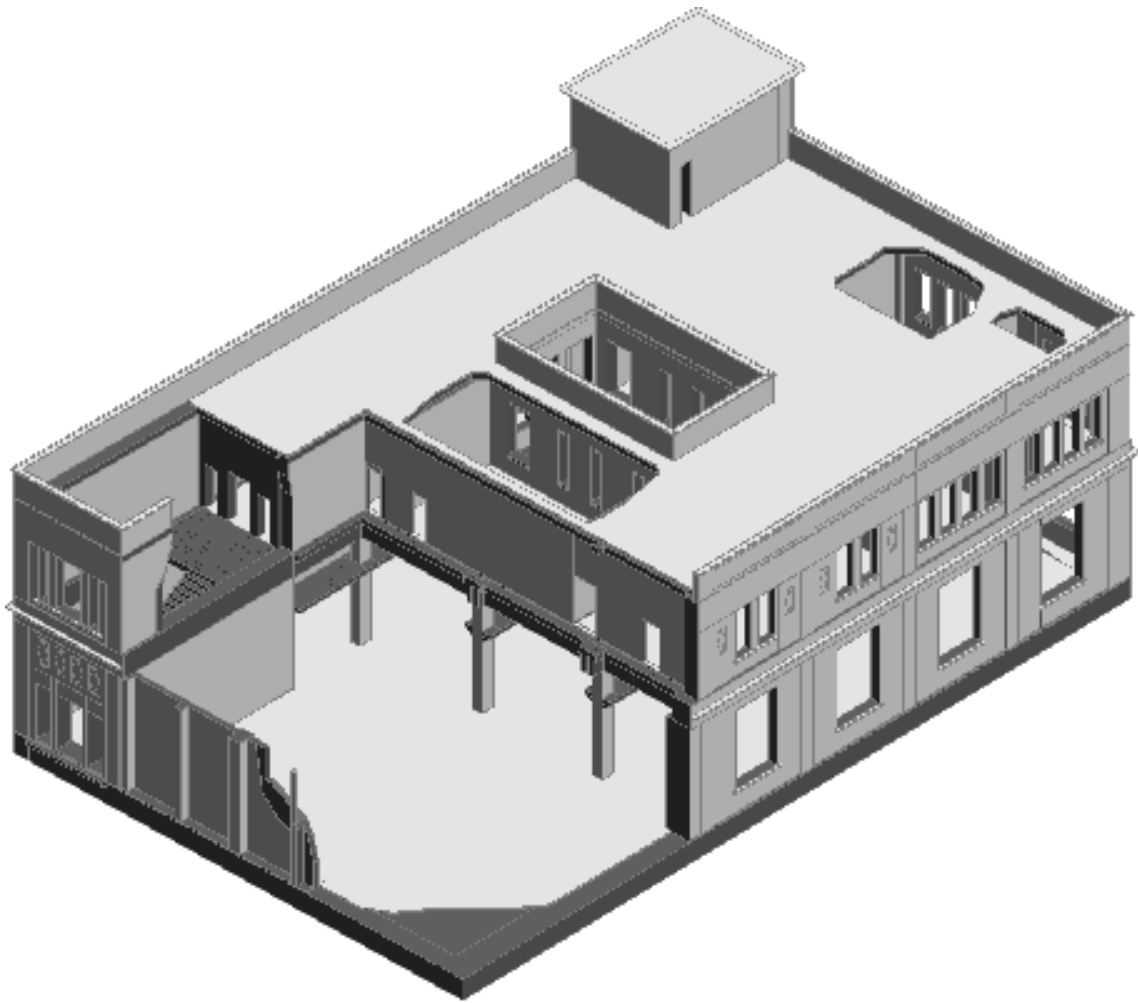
Edificio 11, Uffici e magazzini spedizioni. Stato di fatto rilevato dal gruppo di ricerca, modello informativo BIM.
